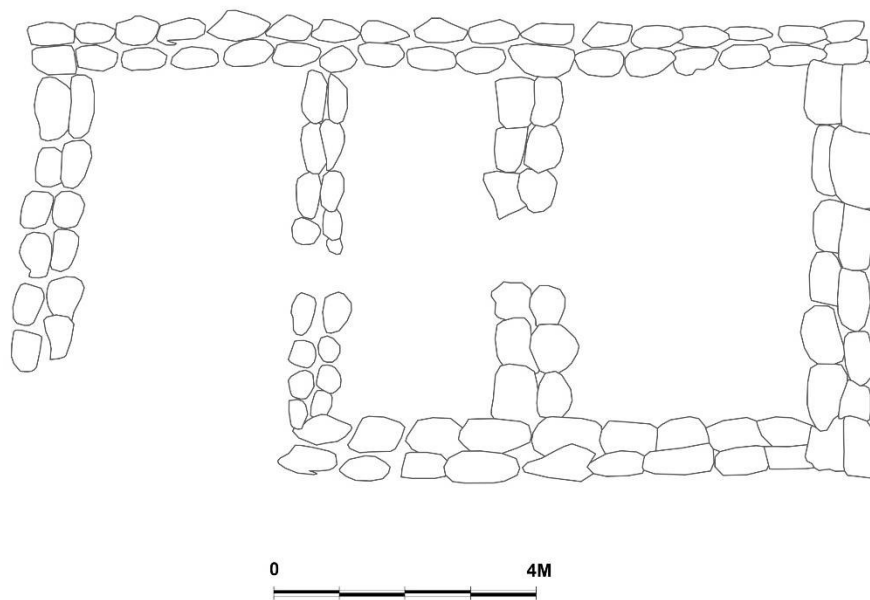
Croquis de la planta del sector A de Cerro Kiway.
